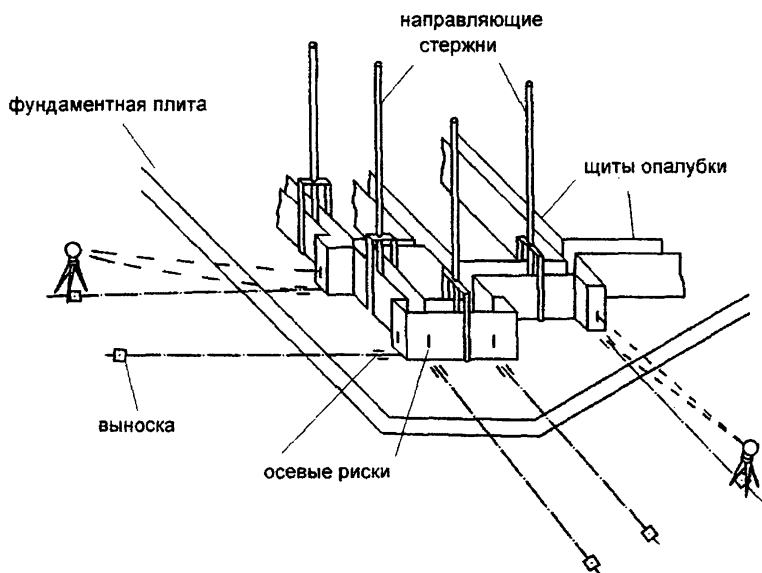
Схема монтажа скользящей опалубки на фундаментной плите
